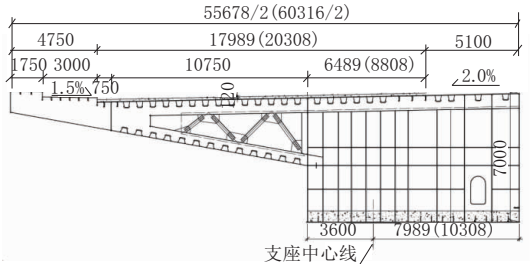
济南凤凰路跨大堤引桥横断面图(单位:mm)
